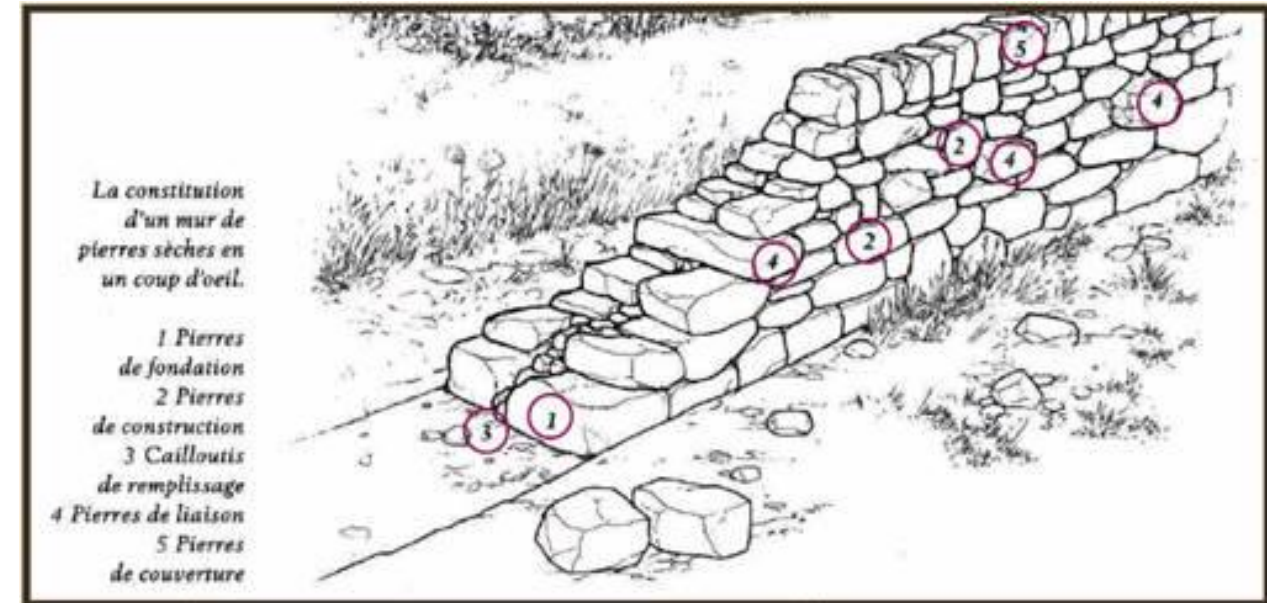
Exemple de construction d'un mur en pierre sèche favorable à la biodiversité
